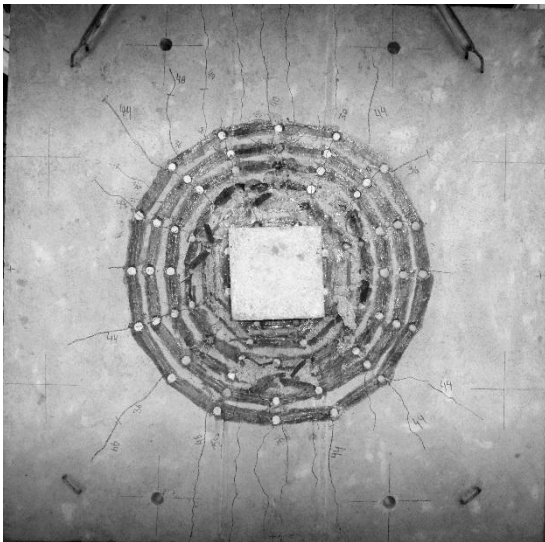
Padrão de Fissuração - LR-S2-6
